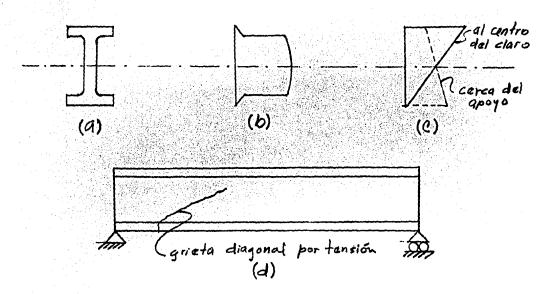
Agrietamiento por tensión diagonal en vigas I de concreto presforzado. (a) Sección transversal. (b) Variación de los esfuerzos cortantes. (c) Variación de los esfuerzos de flexión. (d) Ubicación probable de la grieta diagonal.
